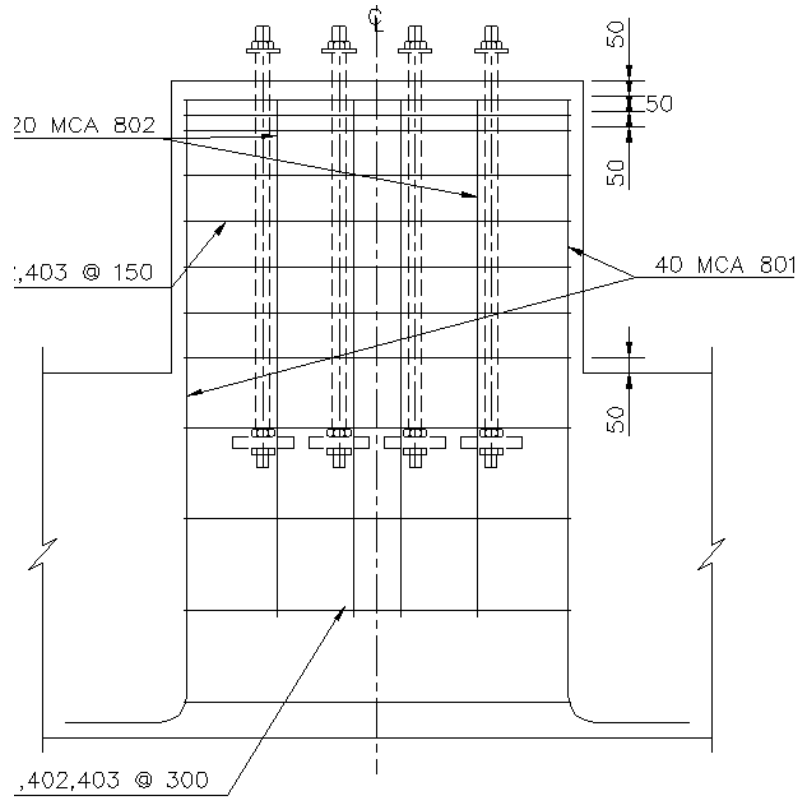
Armado de acero para cabezal y dado de concreto.
